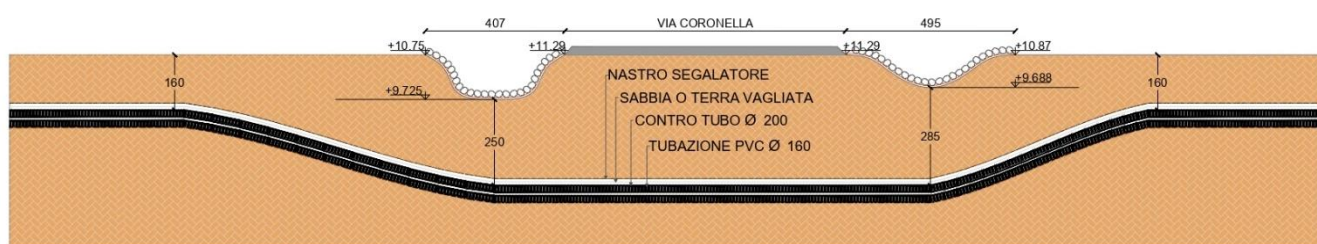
Tratto B-B' - Sezione attraversamento Via Coronella con la TOC
